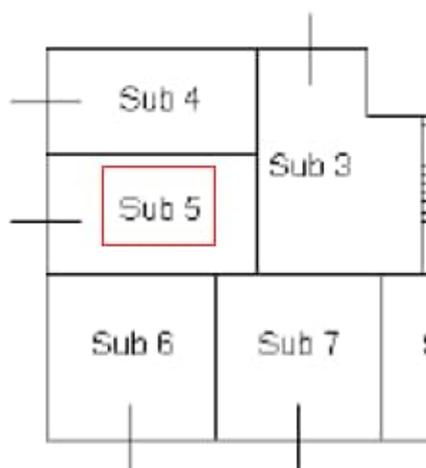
Estratto dell'Elaborato Planimetrico, dal quale dedurre i confini del subalterno 5 (box auto ubicato al piano terra)
